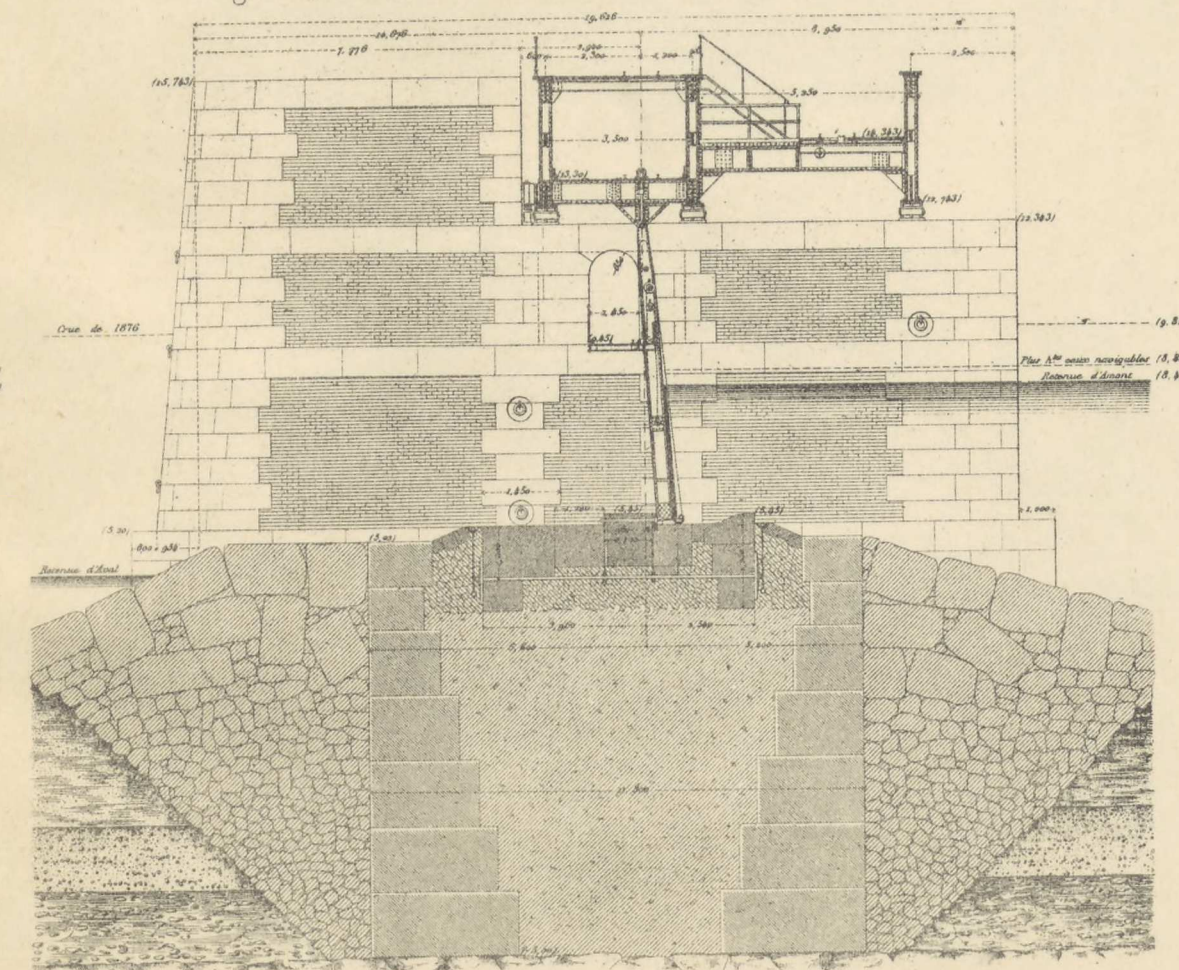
Coupe d'une passe déversoir s' MN et Elevation de la pile N° 3.
